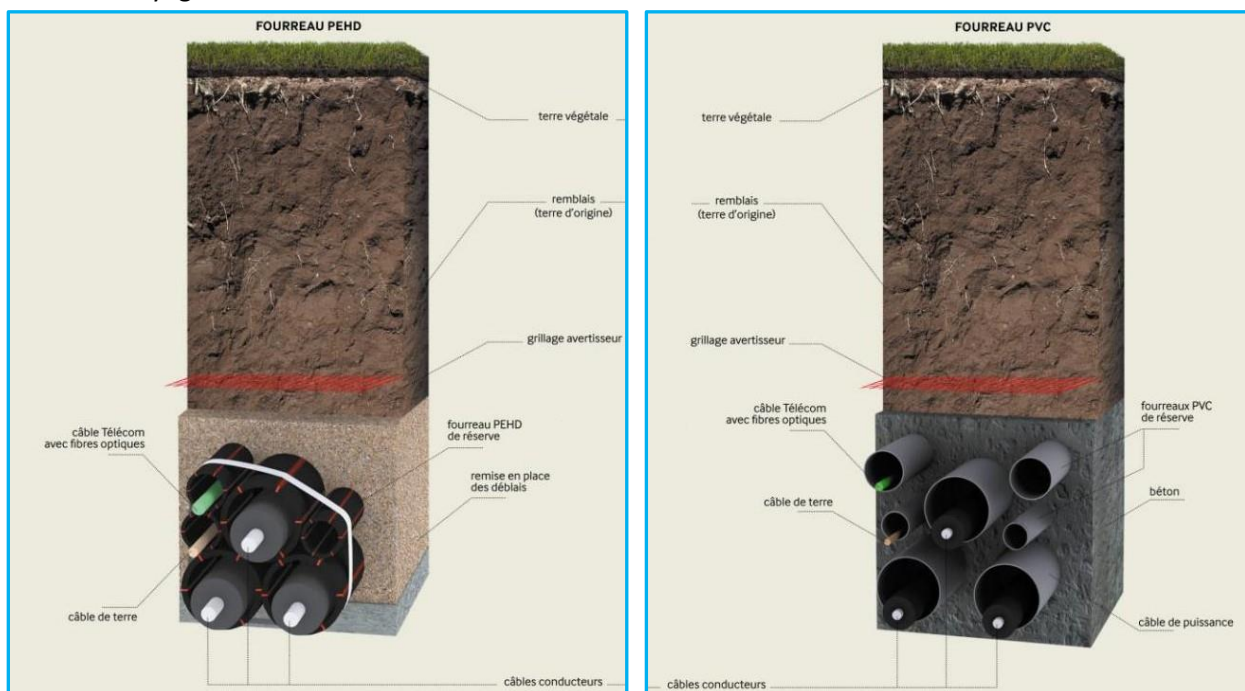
Vue en coupe des techniques de pose en plein champ (PEHD à gauche) et sous voirie (PVC à droite) (Source : RTE)
